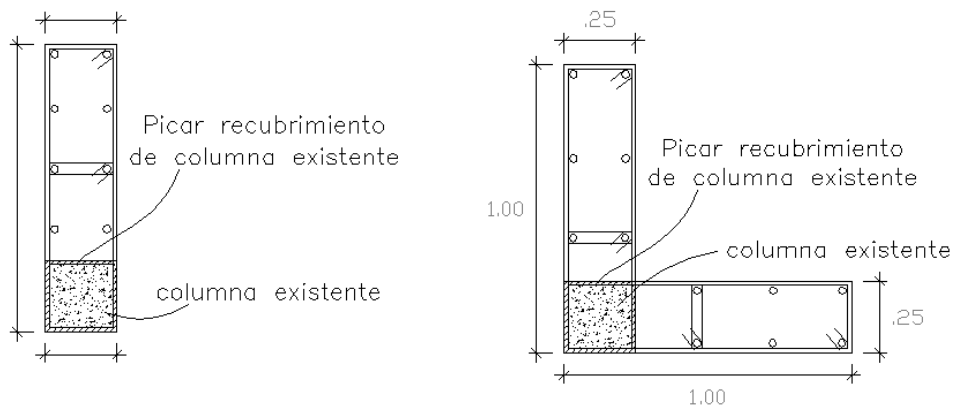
Detalle de reforzamiento para columna existente y esquinera
